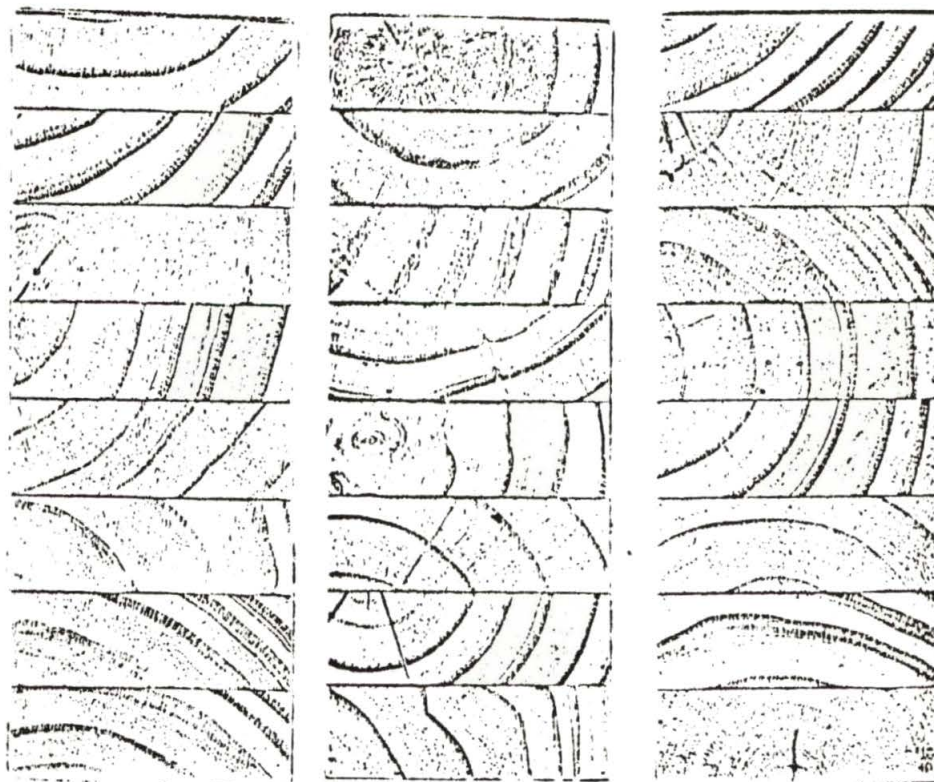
Secção transversal das vigas laminadas VPG (tipo).
